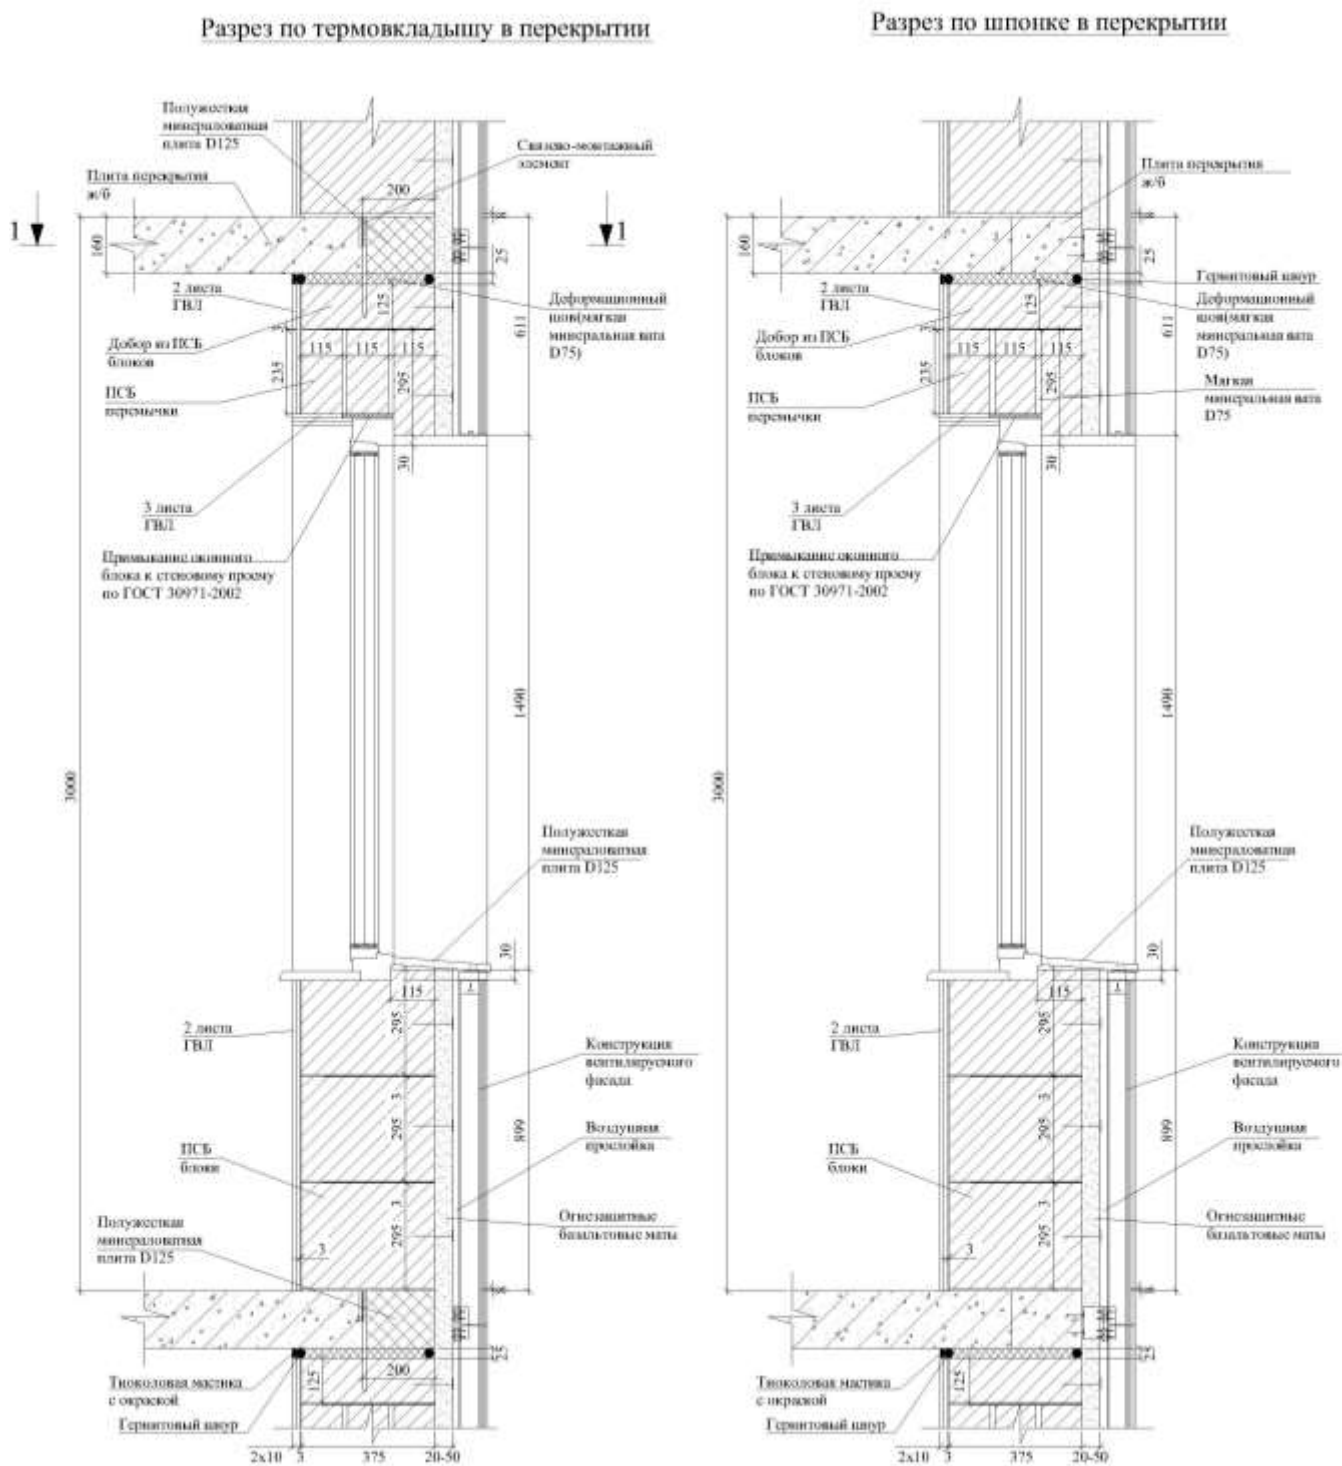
Ненесущая стена из ПСБ блоков с вентилируемым фасадом. Вертикальные разрезы по оконному проему (термовкладышу и шпонке в перекрытии)
